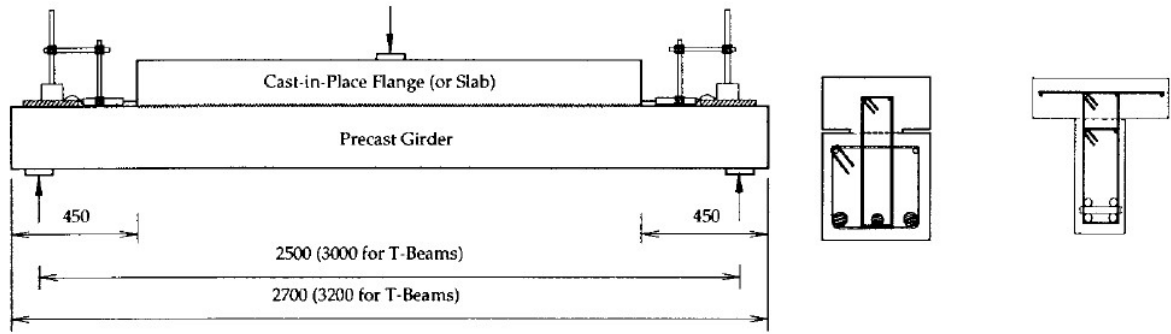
Esquema das vigas simplesmente apoiadas ensaiadas por Patnaik (2001) e respetiva pormenorização das armaduras nos dois tipos de secção contemplados.
